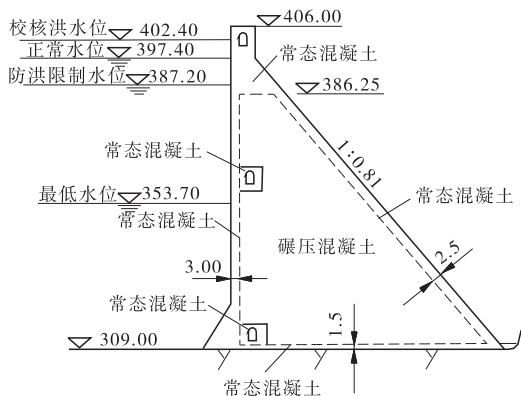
日本玉川碾压混凝土重力坝 (单位:m)
